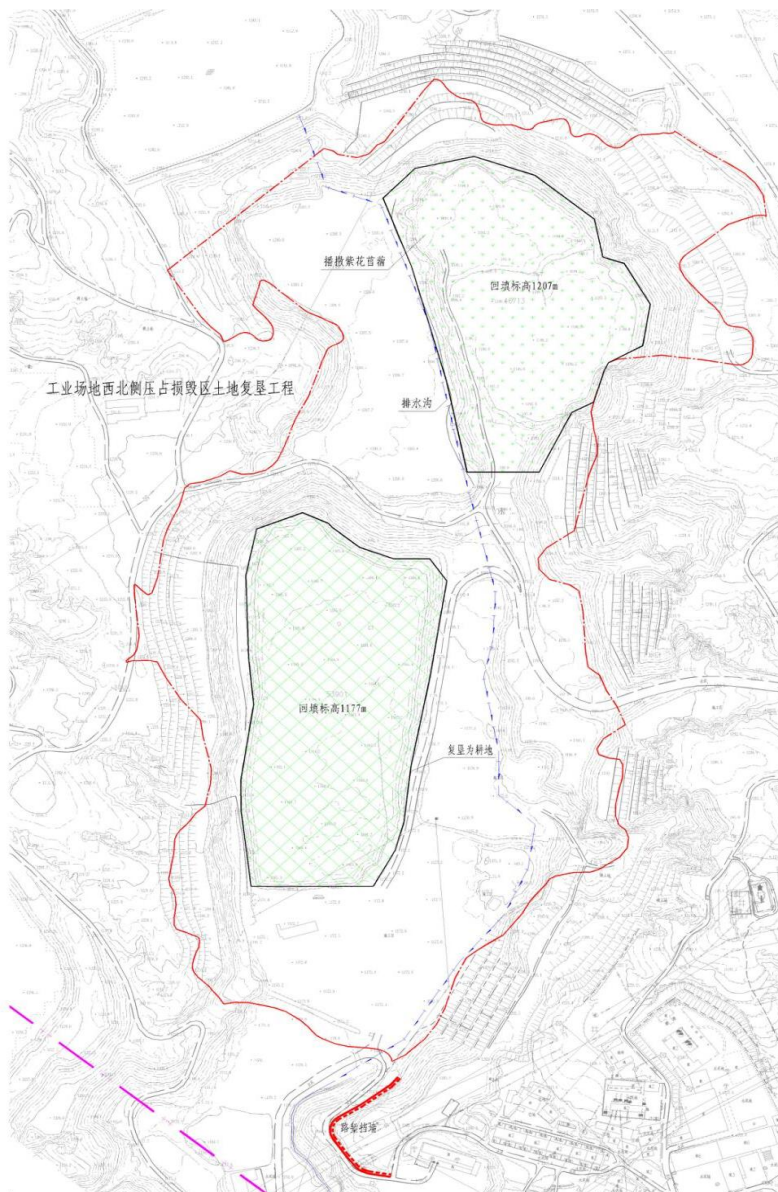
工业场地西北侧压占损毁区土地复垦工程平面图
